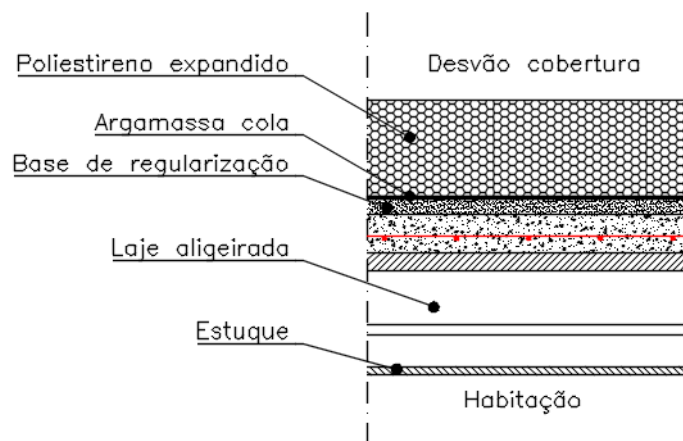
Pormenor construtivo como proposta de intervenção para laje horizontal de cobertura em contacto com desvão cobertura
